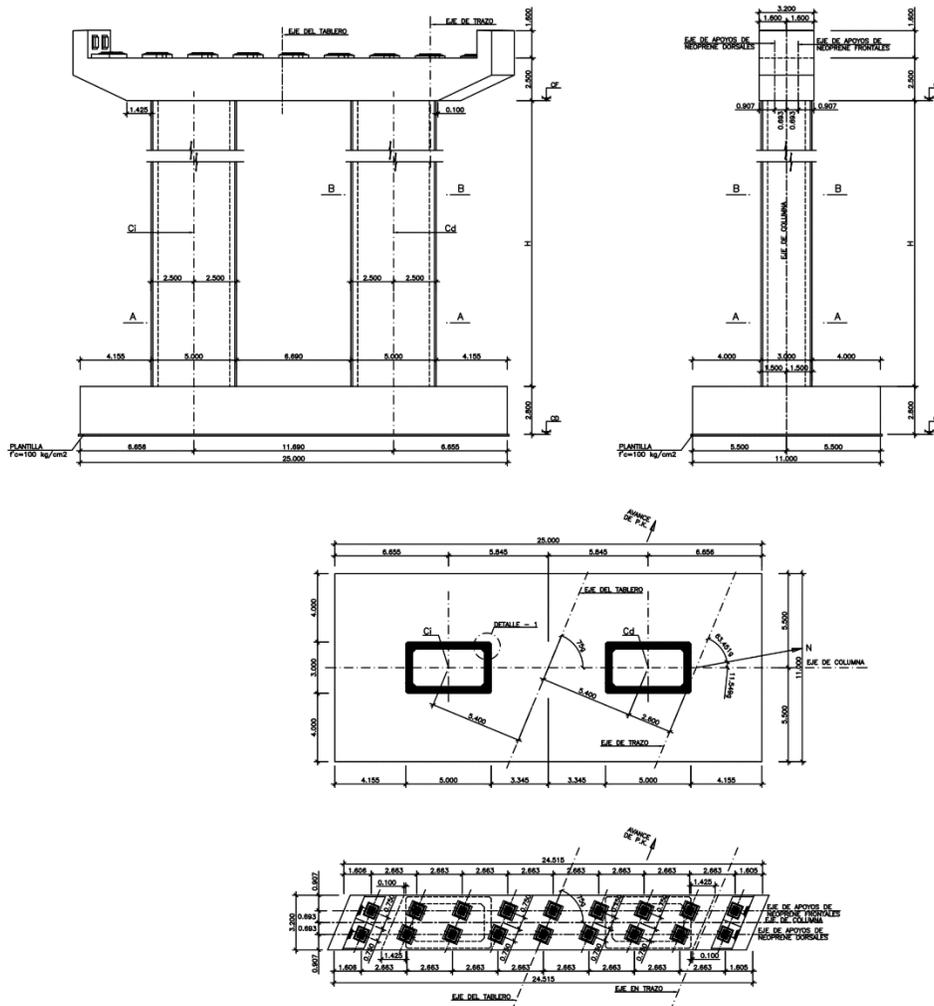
Columnas y sistema de cimentación de proyecto del apoyo 4, viaducto "El salto" CAD 91+857.00.
